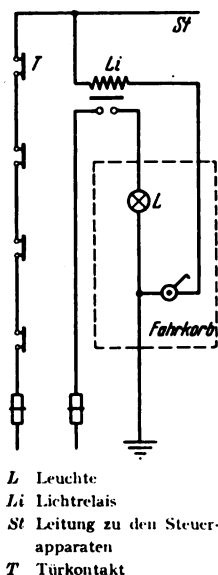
Schaltung für die Fahrkorbbeleuchtung.
